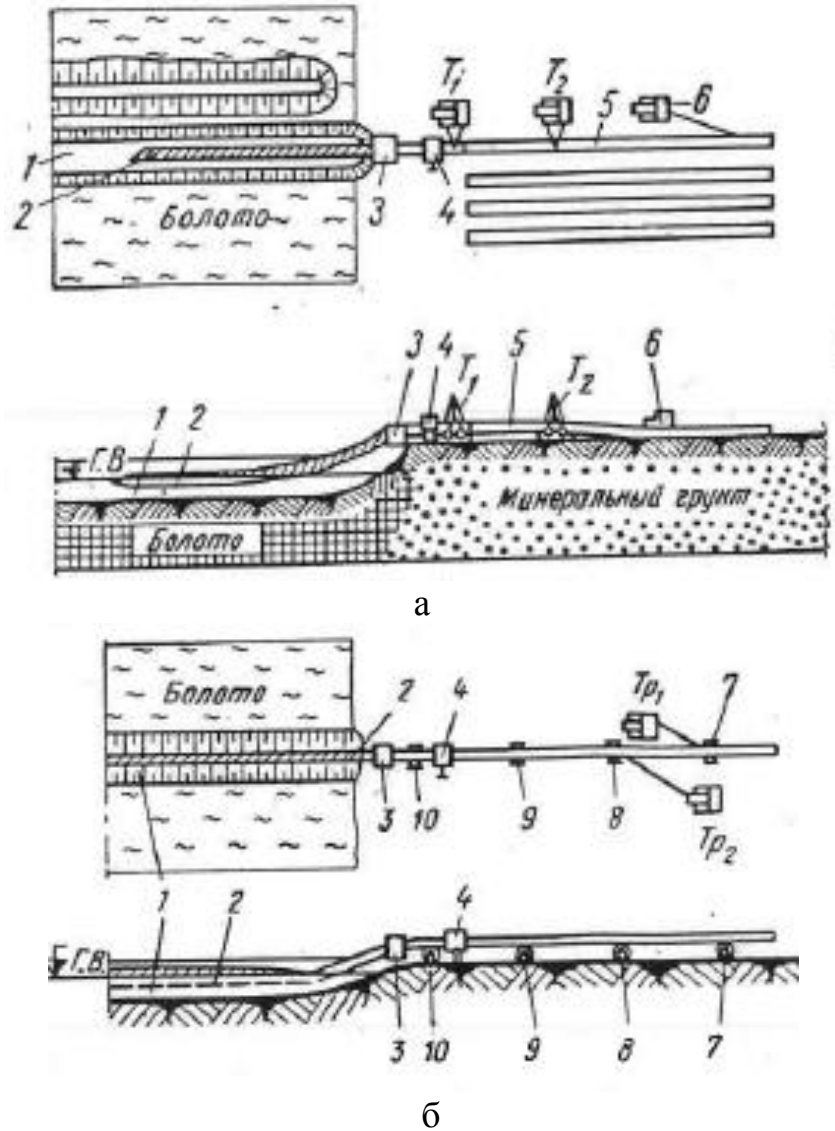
Схема укладки трубопровода: а – схема укладки трубопровода сплавом (вариант 2); б – видоизмененная схема укладки трубопровода сплавом (вариант 2)
